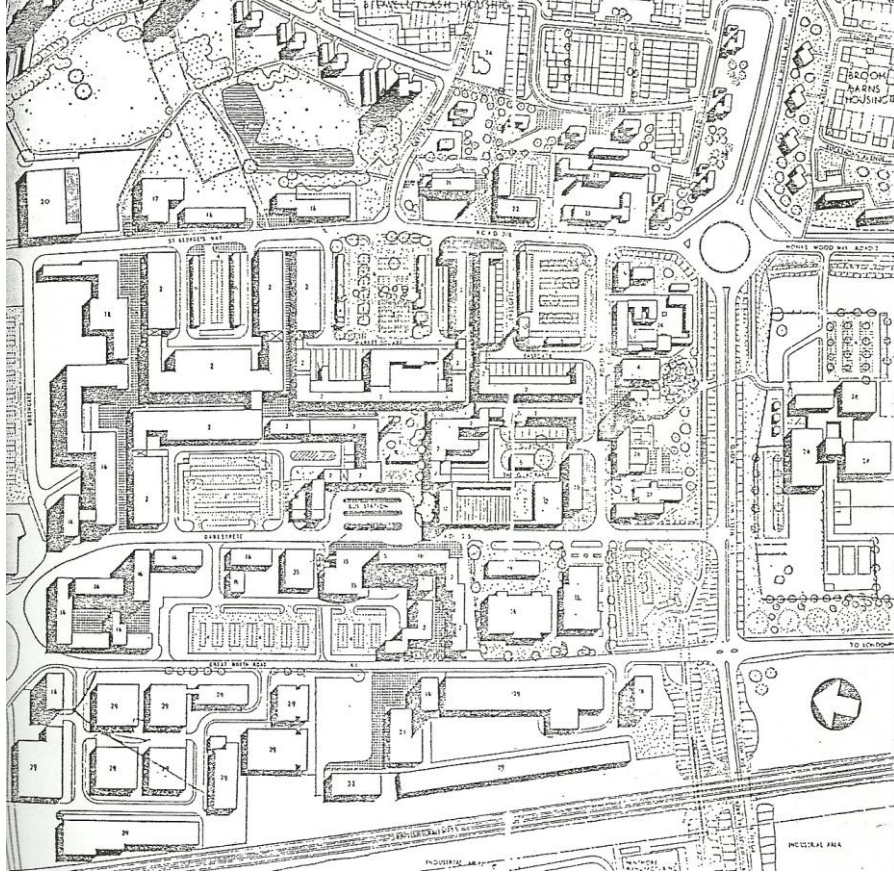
19 Stevenage vaziyet planı<sup>3</sup> [6]
